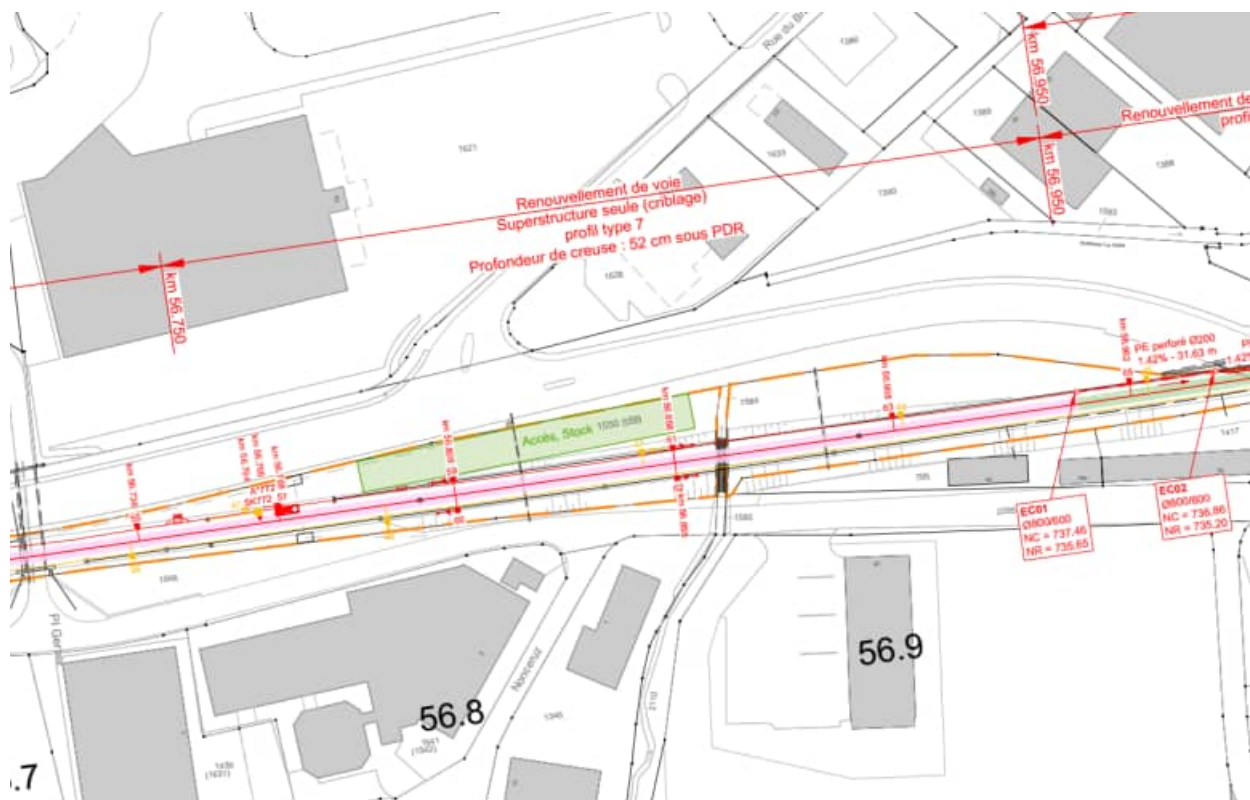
PROJET RIM, EXTRAIT PLAN DE SITUATION 1144-914
